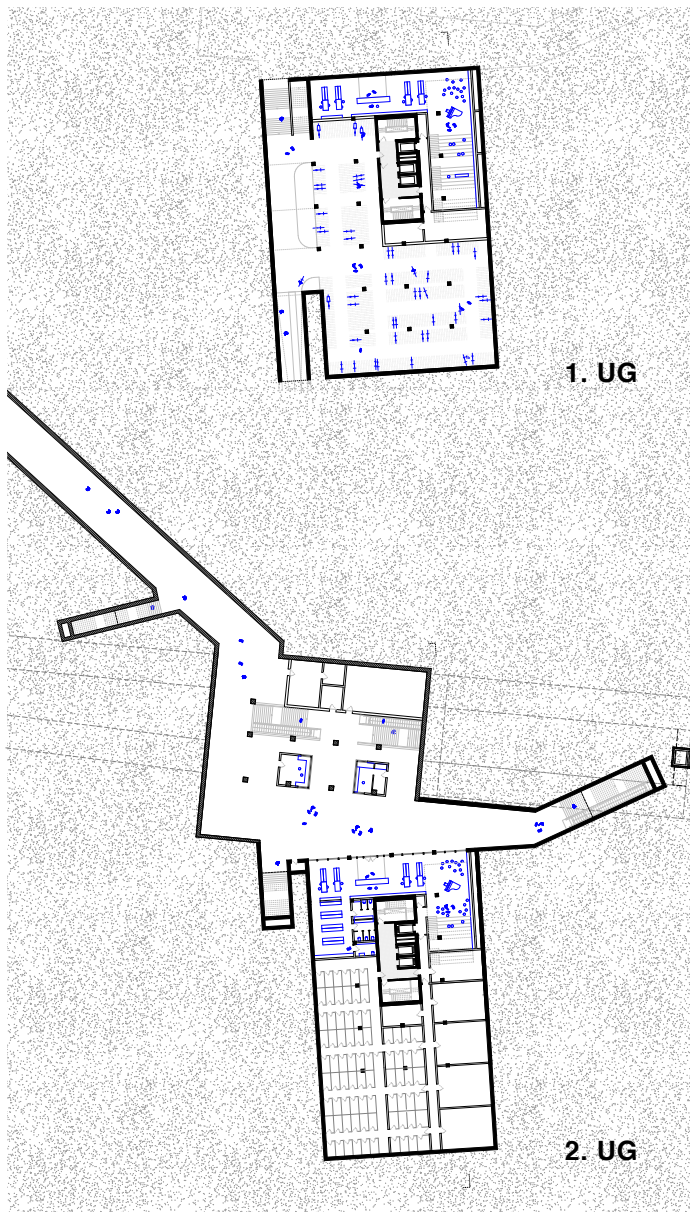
Grundrisse des 1. und 2. Untergeschosses
